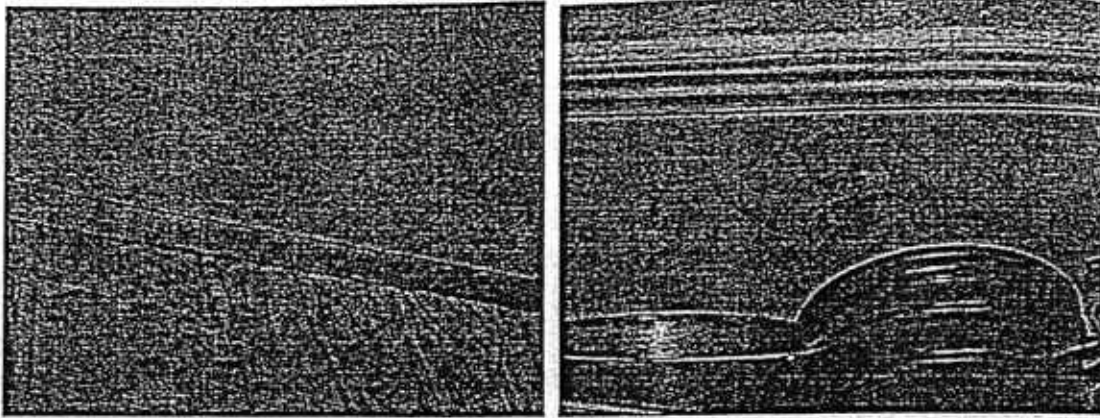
,12, 13,14. Розкриття тріщин по стикам плит перекриття в приміщеннях квартири № 47.
